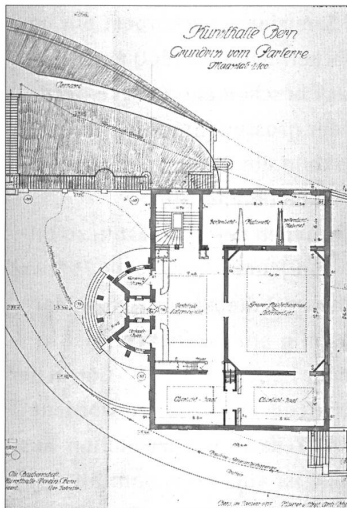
Bern, Kunsthalle: Grundriss.
